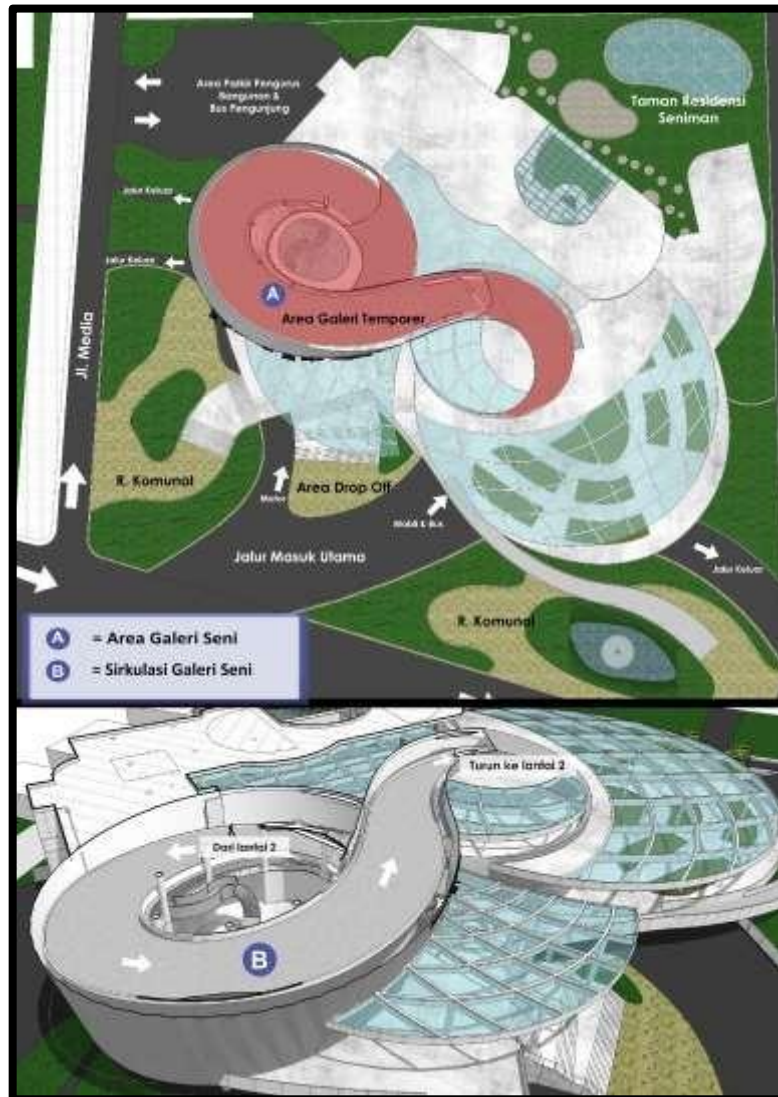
Susunan Ruang Lantai 2 Bangunan Rumah Seni Lukis
